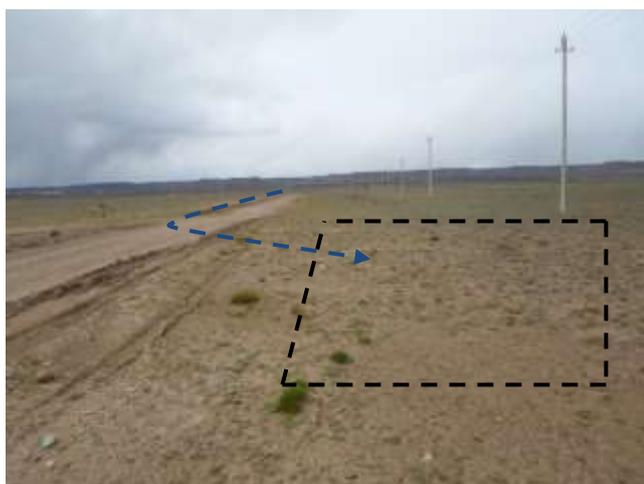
Emplazamiento de acueducto por margen interno de camino. Cruce con camino y fin de acueducto en futuro satélite inyector LCO. Foto en dirección E.
